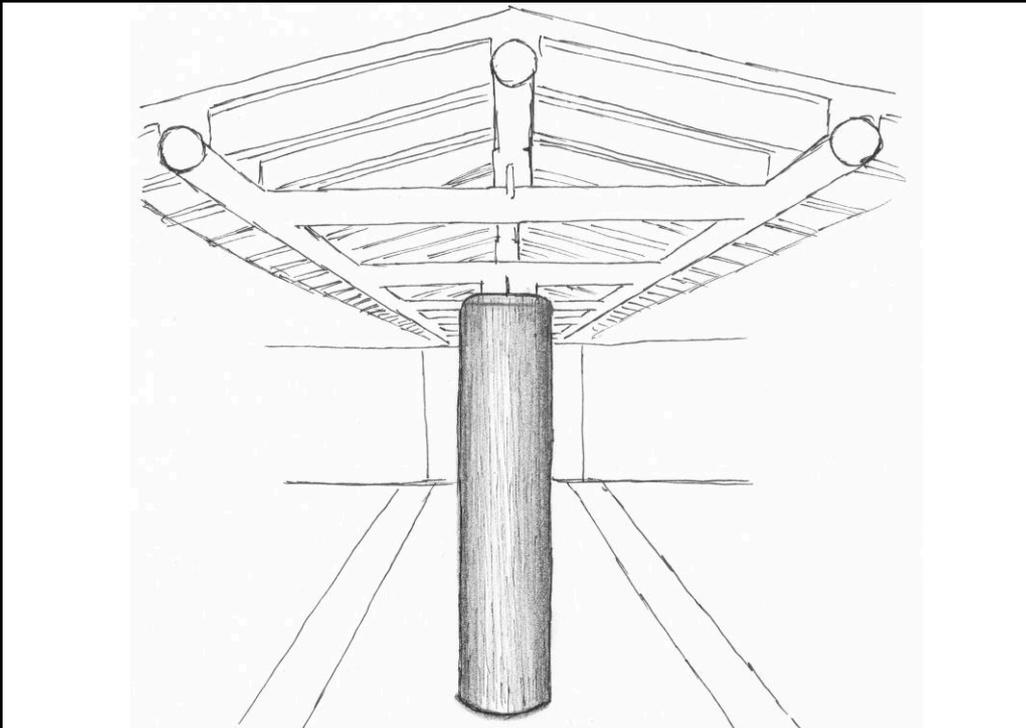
Croquis d'une colonne en pierre soutenant la verrière extérieure.
